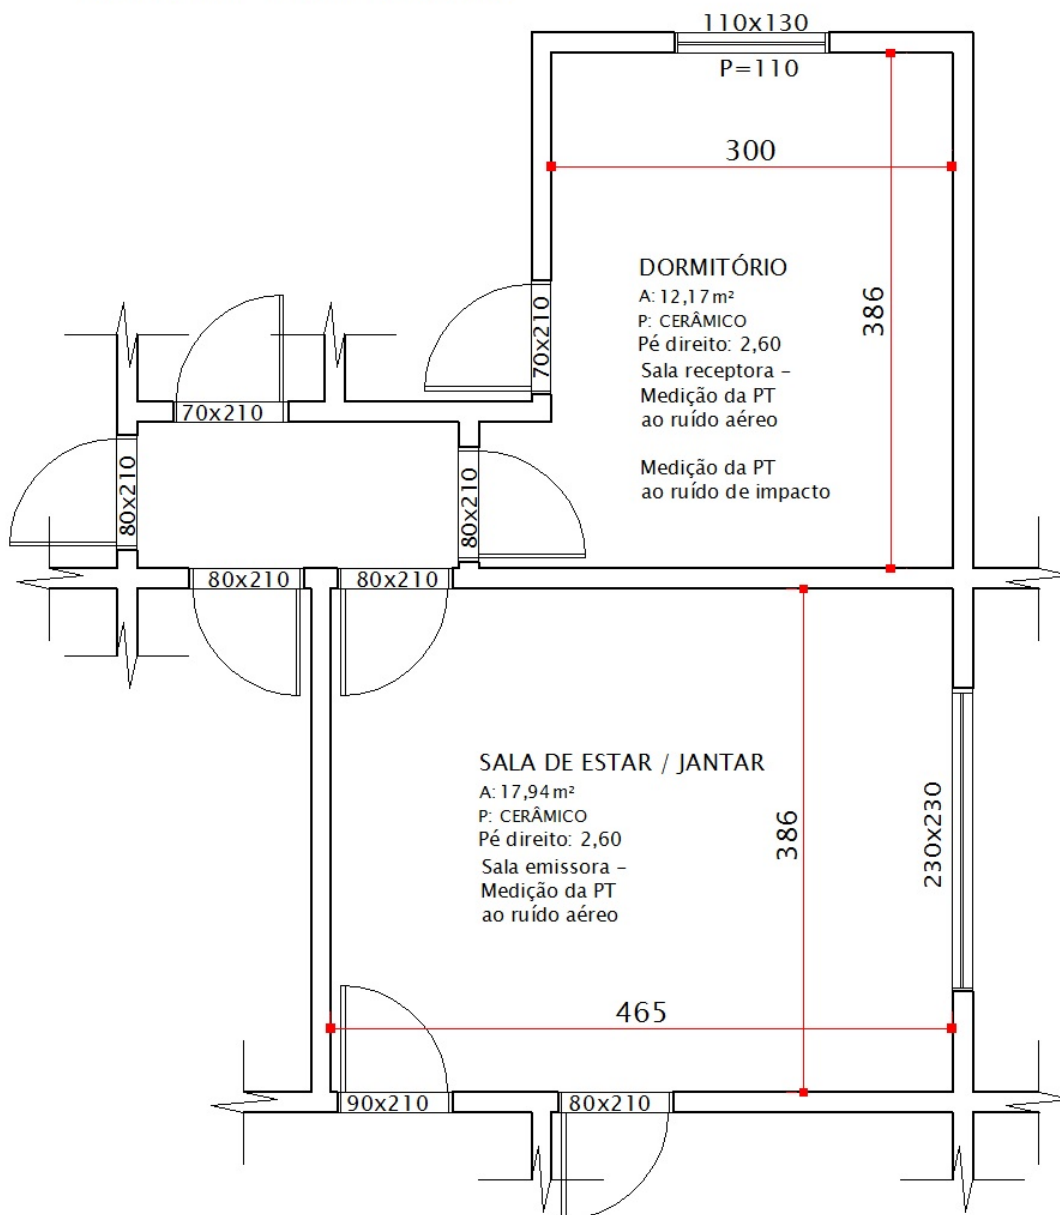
Planta baixa - pavimento tipo - 12-R8-N-BCE-PC
